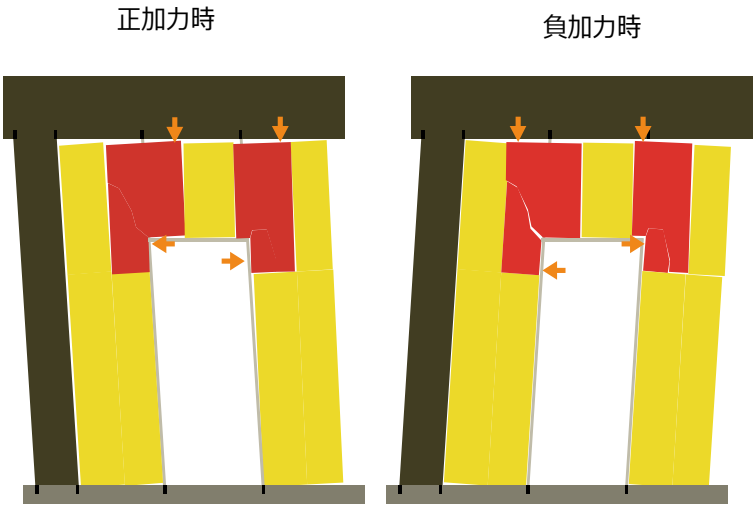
C 面に生じた上張りボードのひび割れのイメージ図
